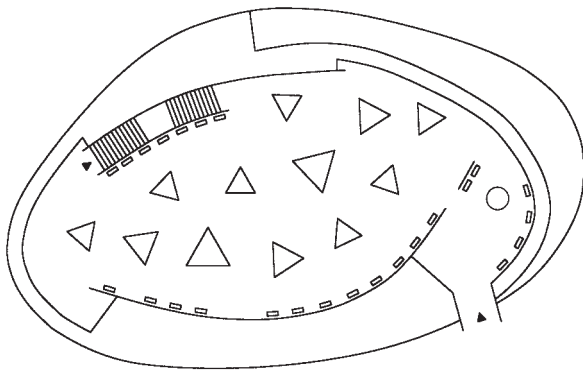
Grundriss der Ausstellung „Das Weltmeer“: Raumbild „Unendlichkeit“. Zeichnung: Atelier Lohrer.
